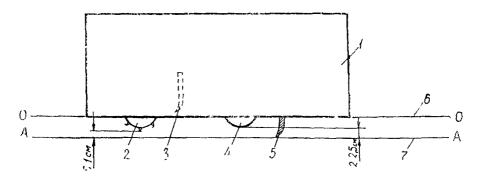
Схема установки рабочих органов при планировке грунтового основания без фрезерования грунта:
